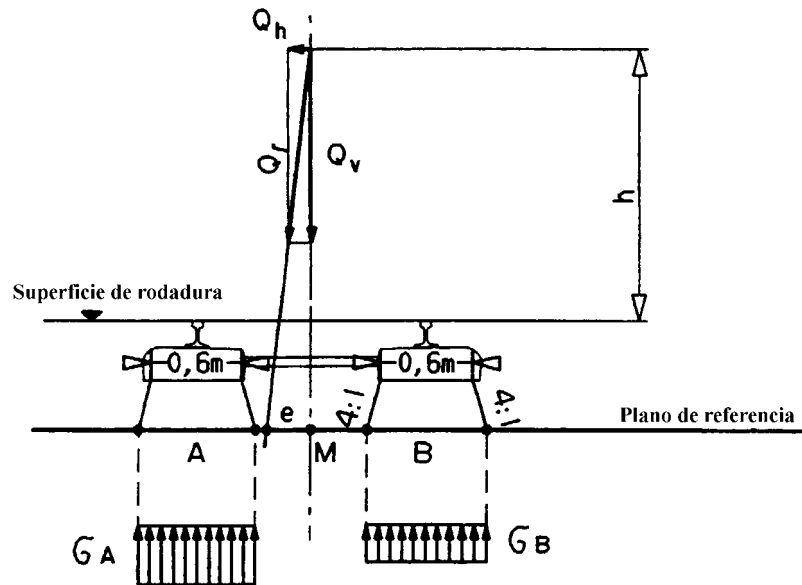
Distribución transversal de las cargas a través de las traviesas y del balasto en vías sin peralte
